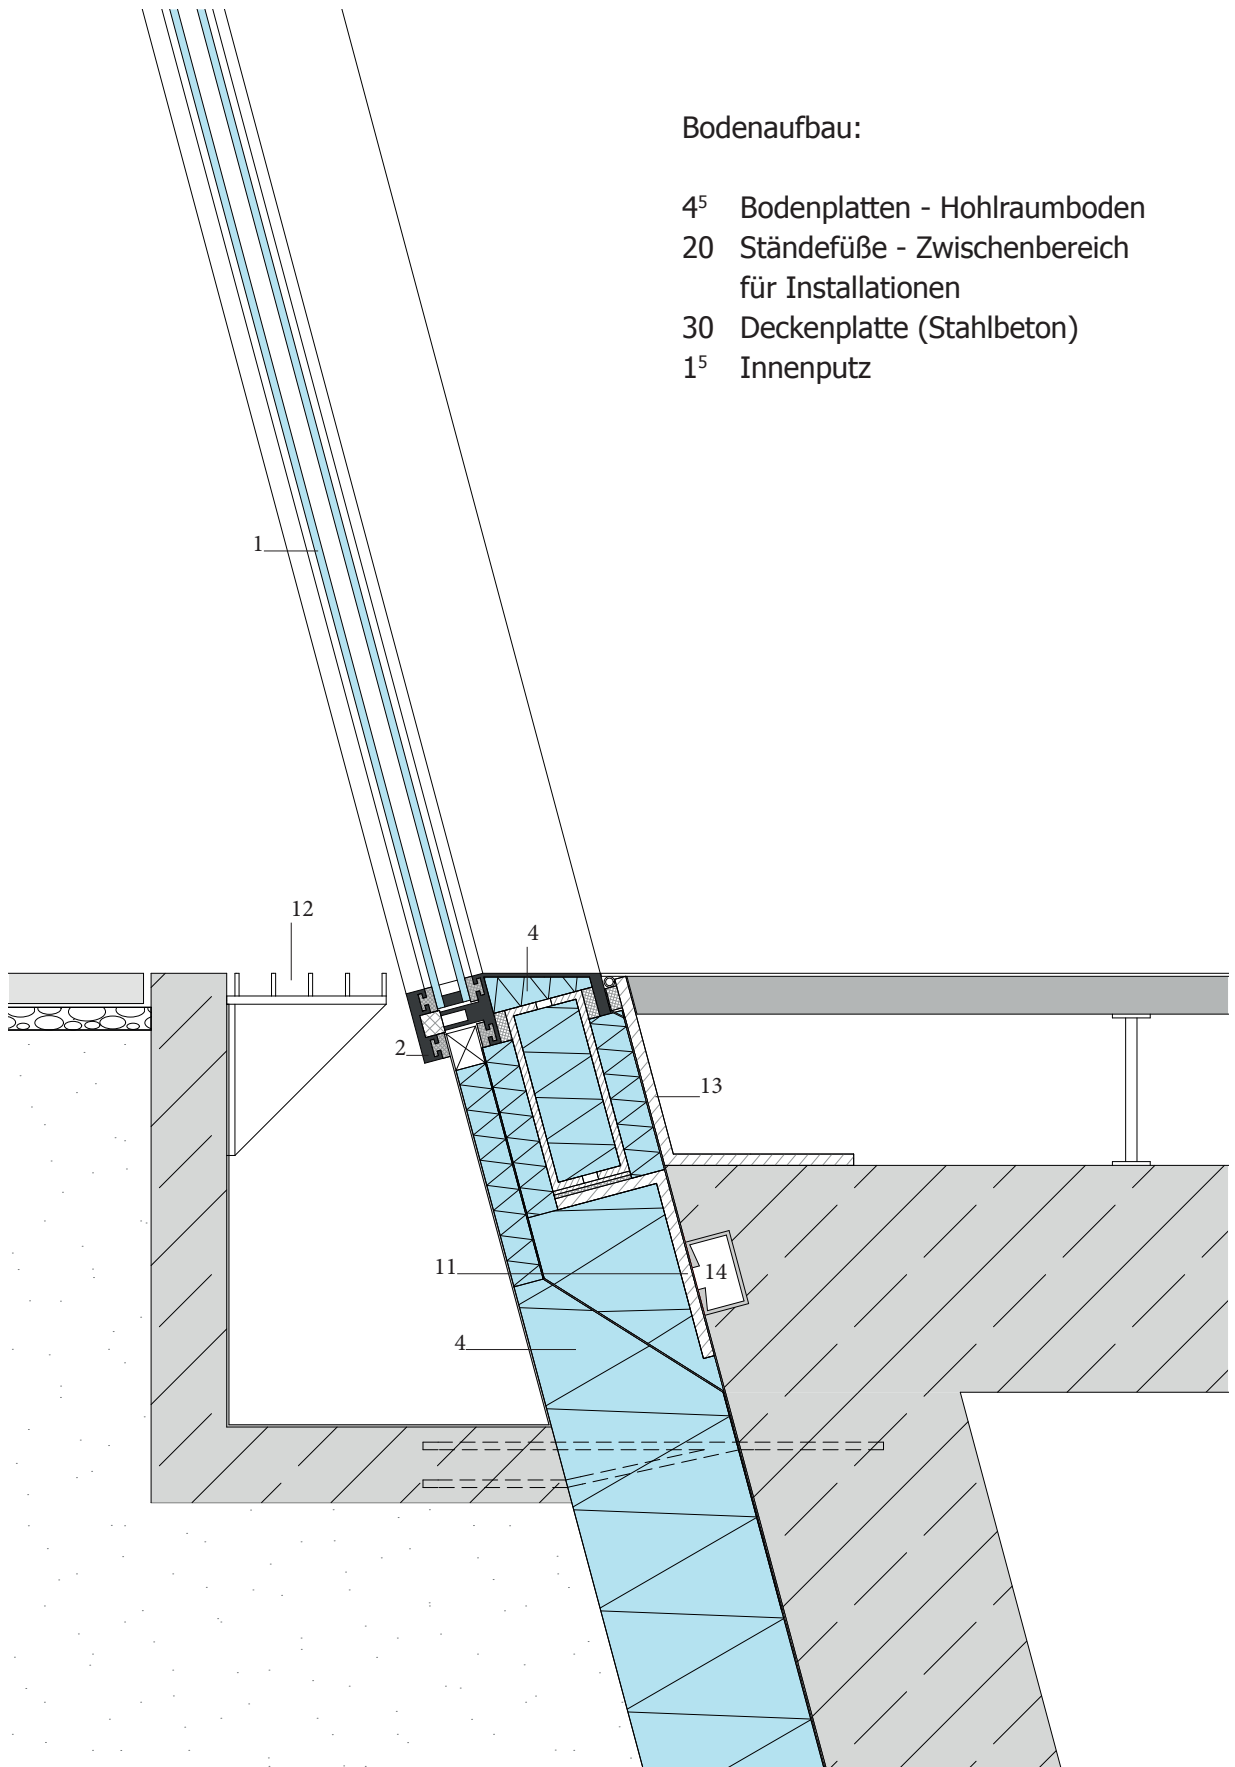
Fassadenschnitt 3D - Regelgeschoss
